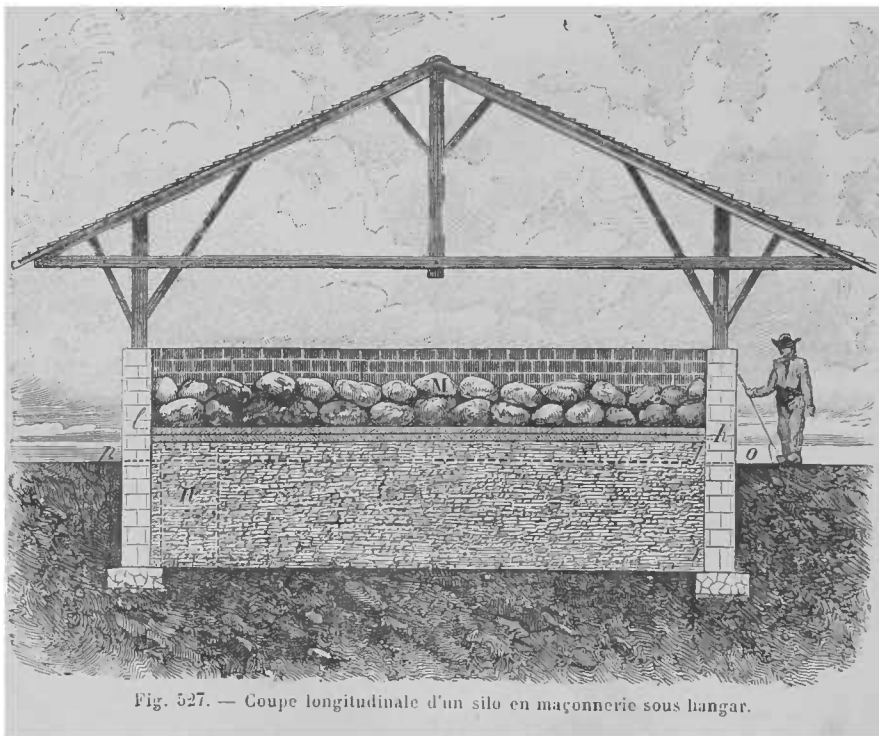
Coupe longitudinale d'un silo en maçonnerie sous hangar.
